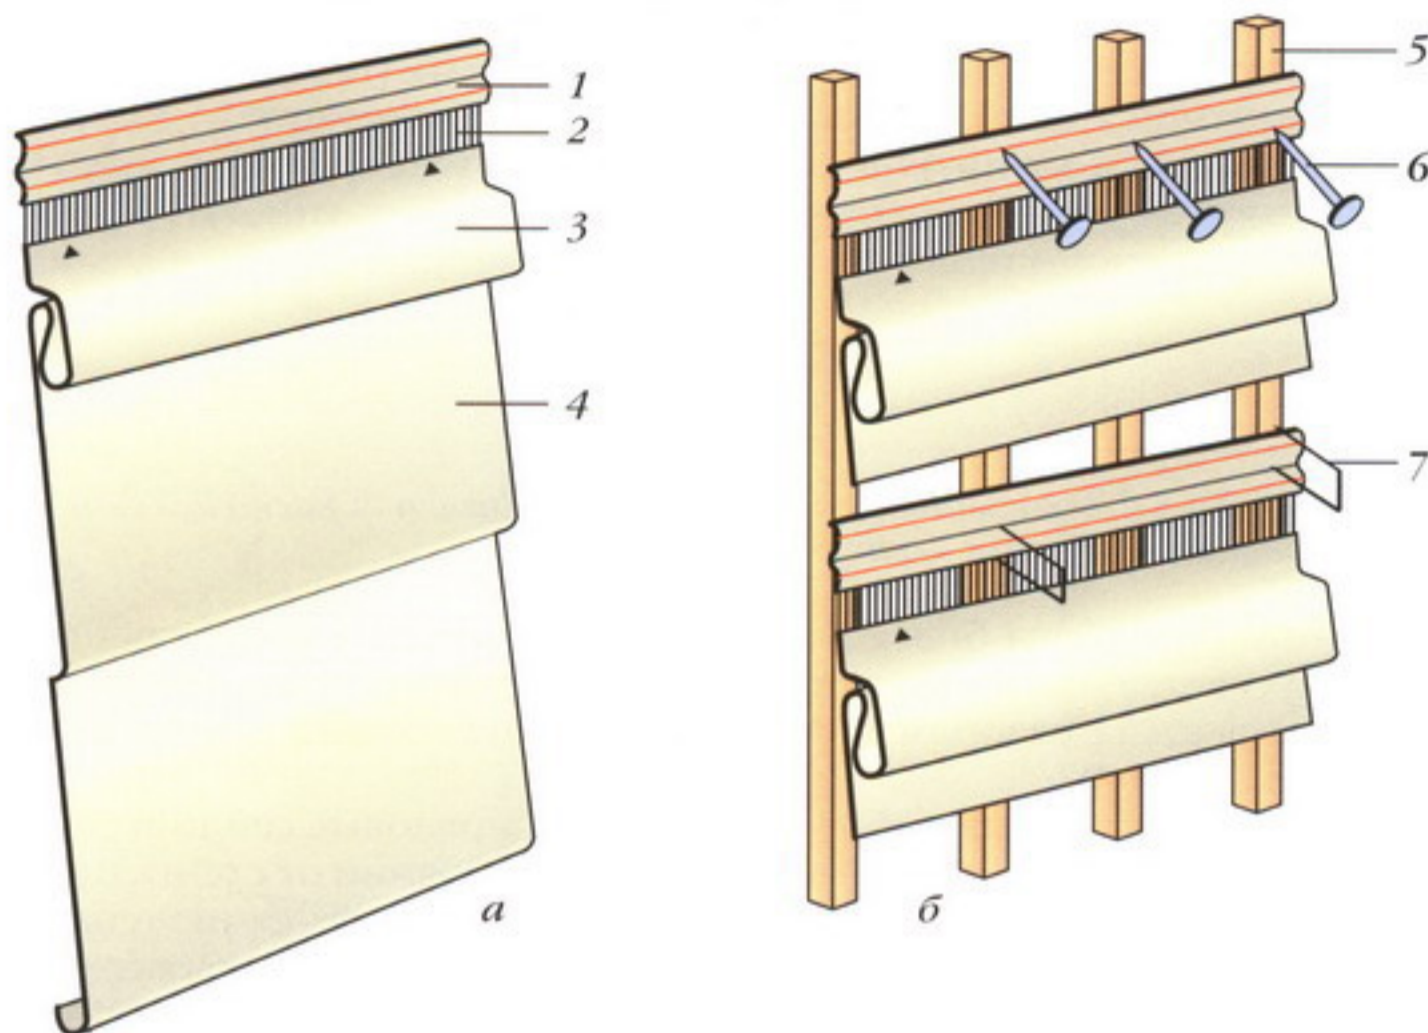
Крепление гибкого сайдинга: а — общий вид рядовой панели; б — установка крепежей; 1 — гвоздевая планка; 2 — связующие синтетические нити; 3 — замок; 4 — форм-фактор; 5 — обрешетка; 6 — гвоздь или саморез; 7 — скоба
